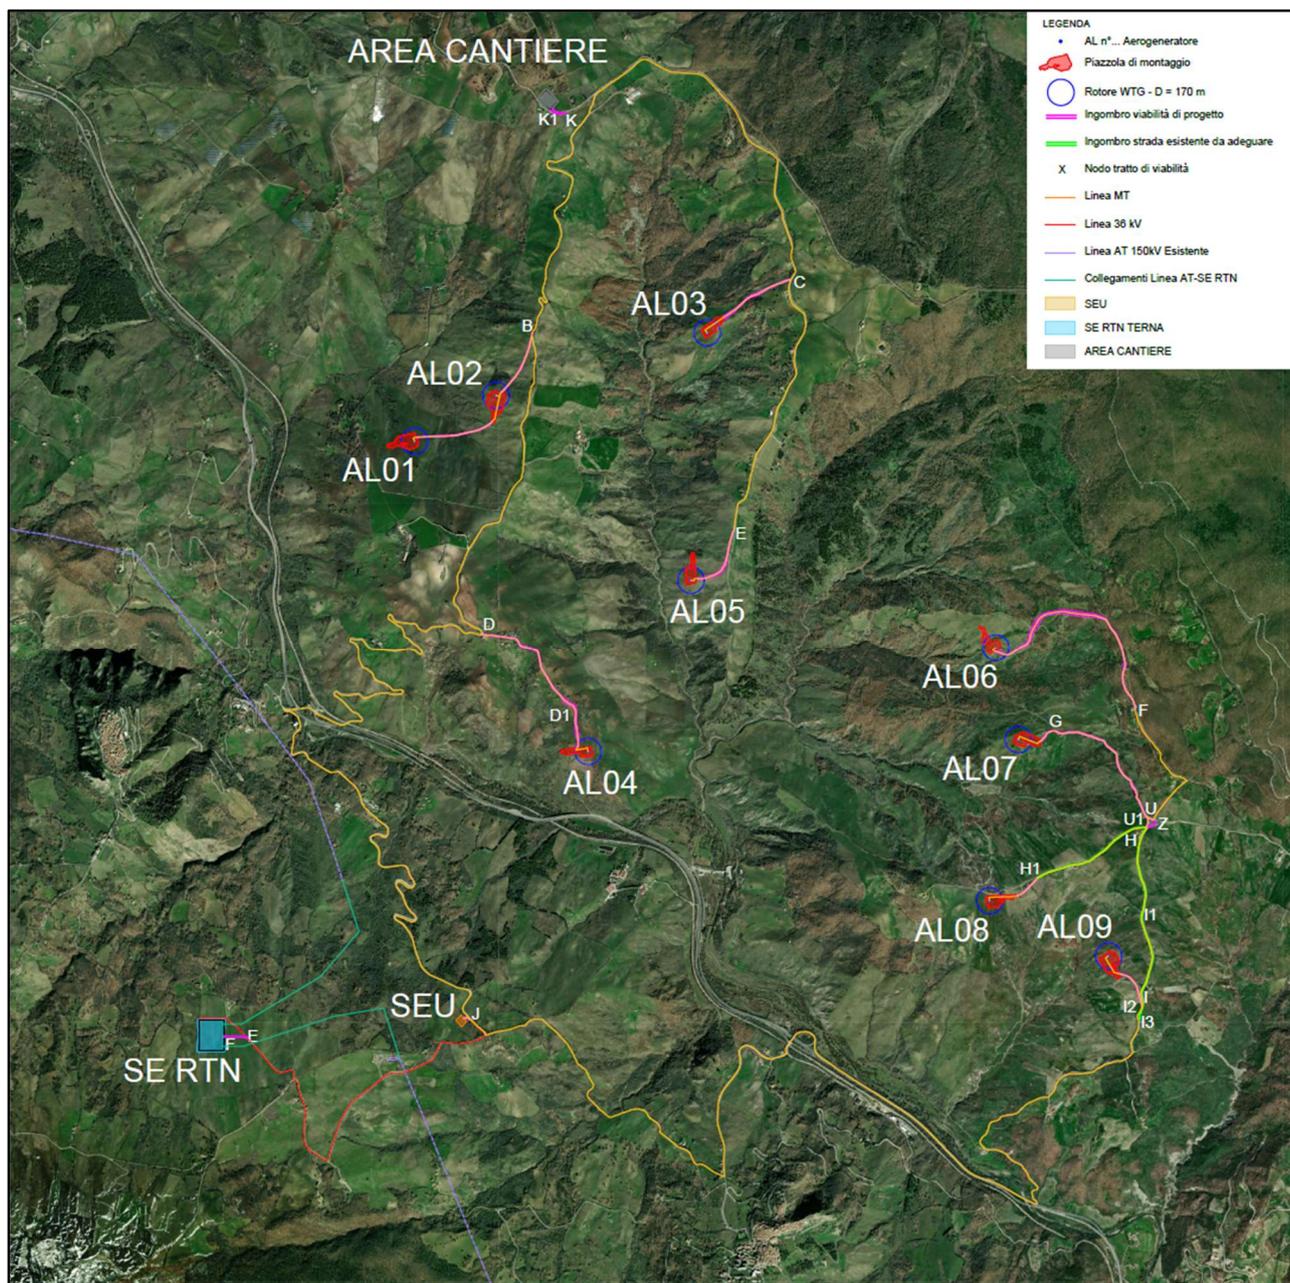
Planimetria viabilità in fase di montaggio
